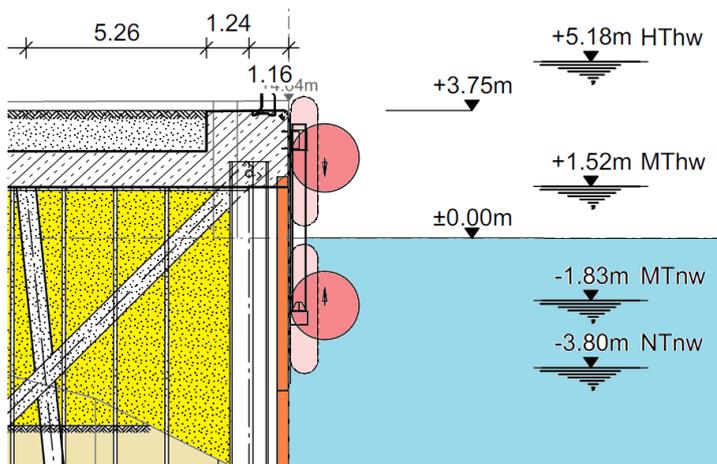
Schwimmfender in oberer und unterer Lage, Querschnitt
